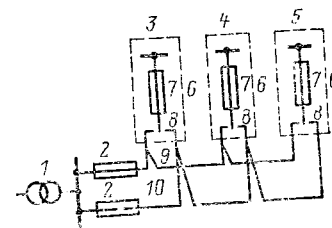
Схема питания жилых домов высотой до 5 этажей с переключателями на вводах:
